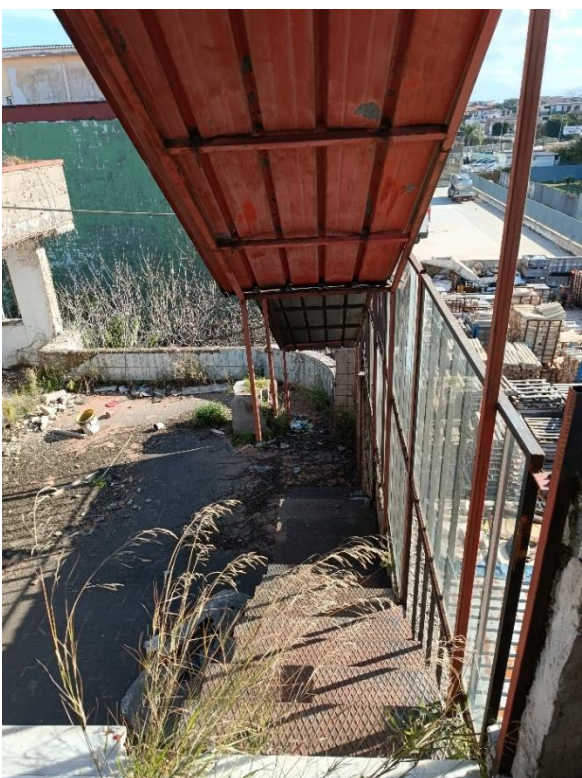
Scala di accesso dal quota lastrico solare piano primo a quota terrazzo piano primo Foto 28: immobile costruito a quota lastrico solare del piano primo
